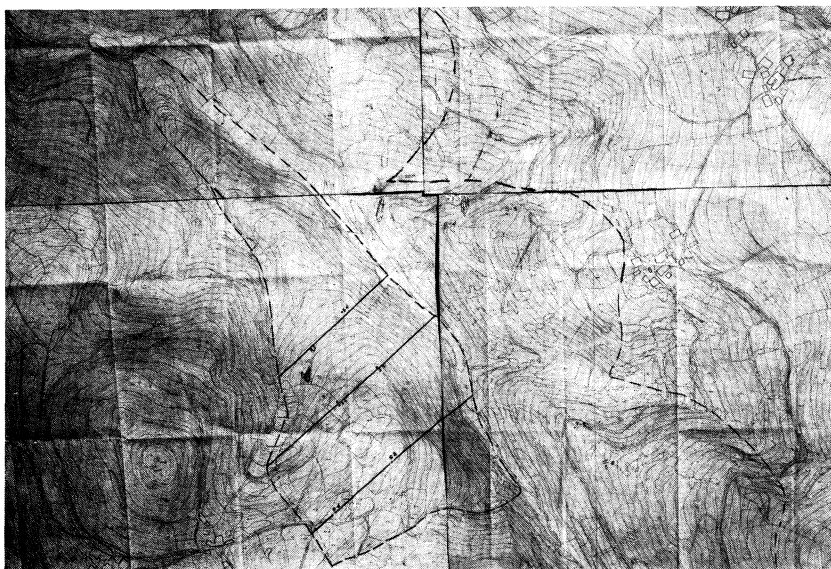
°.- Situación en planta de sondeos de Morro grande de Vilar
